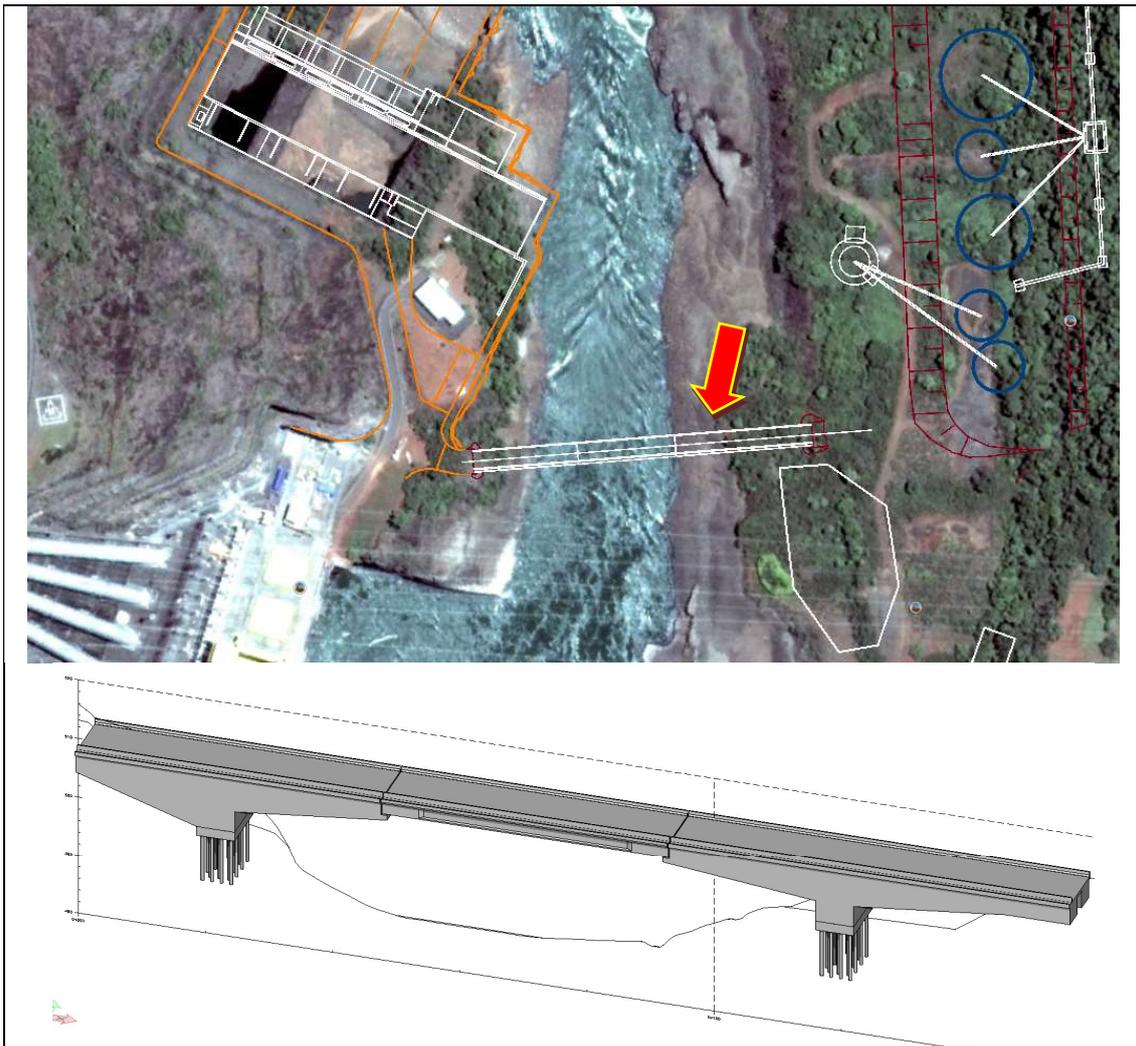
Ponte em concreto armado e protendido para acesso à nova Casa de Força
